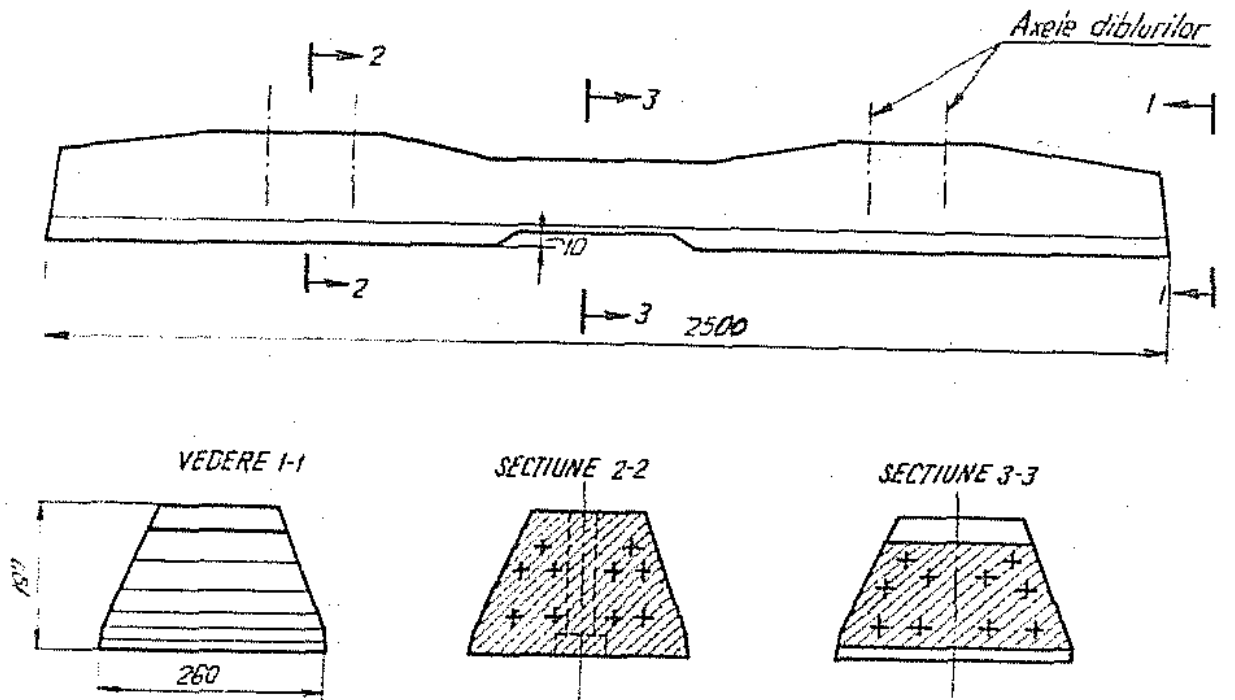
Traversa de beton armat precomprimat forma T₈
